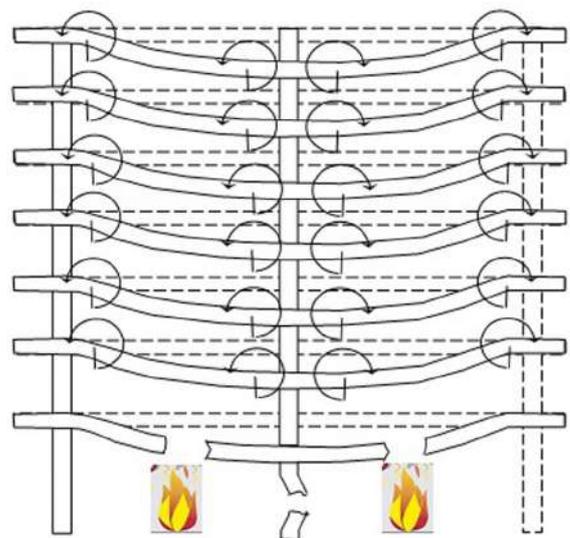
Розрахункова схема для розрахунку прогресуючого руйнування будівлі із залізобетонними конструкціями
